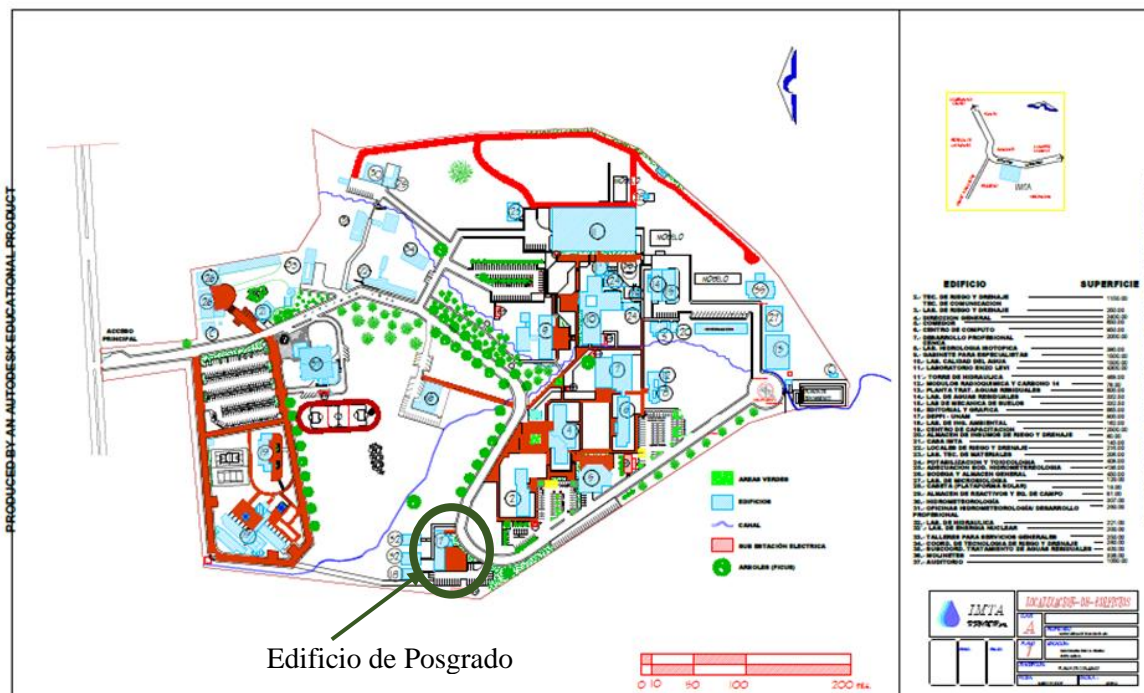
Plano del (IMTA), clave A, plano 1, (IMTA, 2009)
